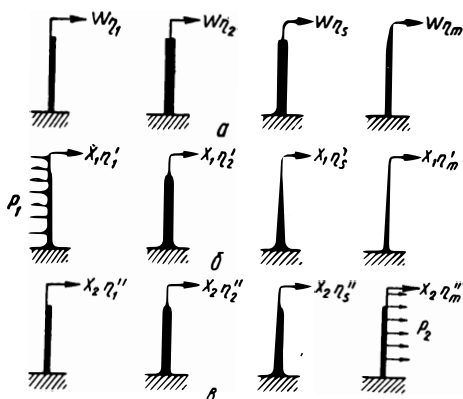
Расчетные схемы колонн поперечной рамы от ветровой нагрузки:
